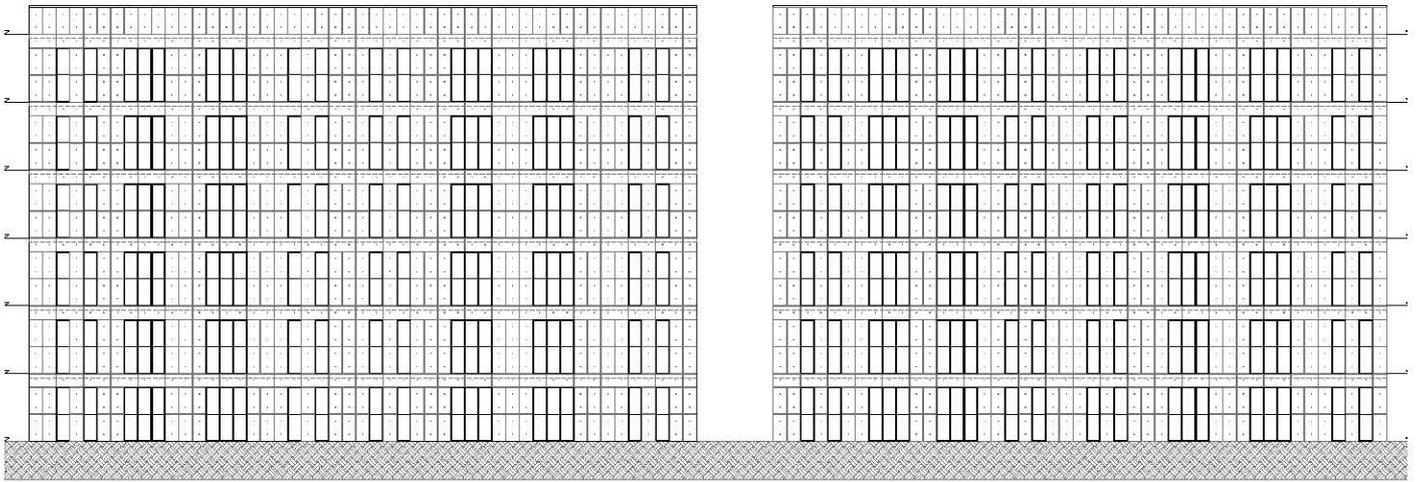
Fachada del nuevo edificio 3-B de cara a la plaza del conjunto
